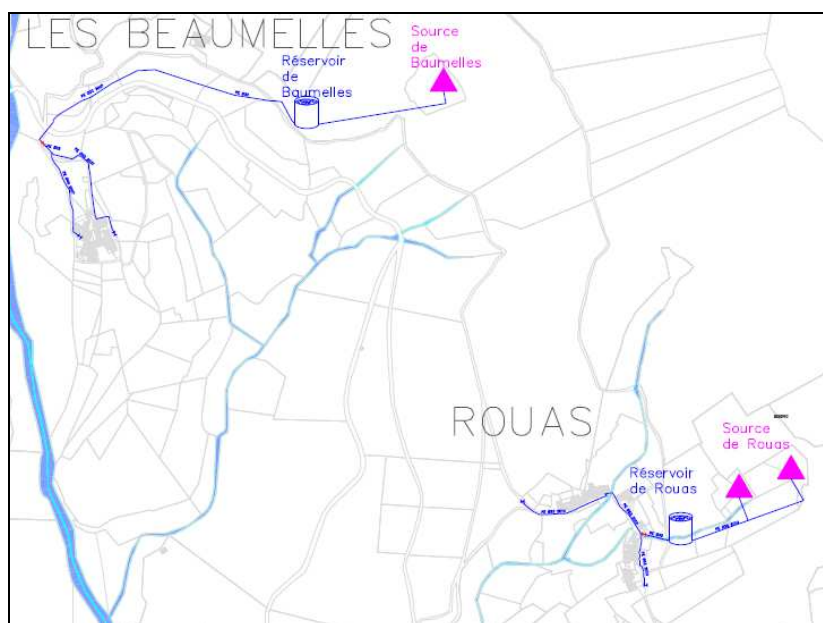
UDI Baumelles – Rouas : Plan réseaux
